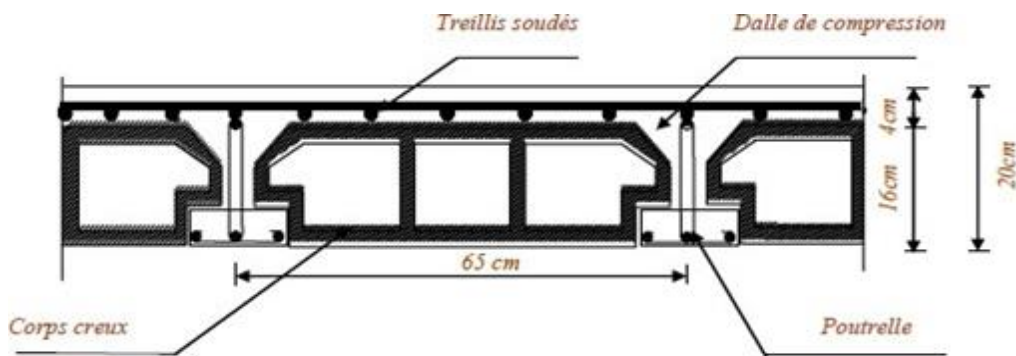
Coupe transversale d'un plancher à corps creux.
